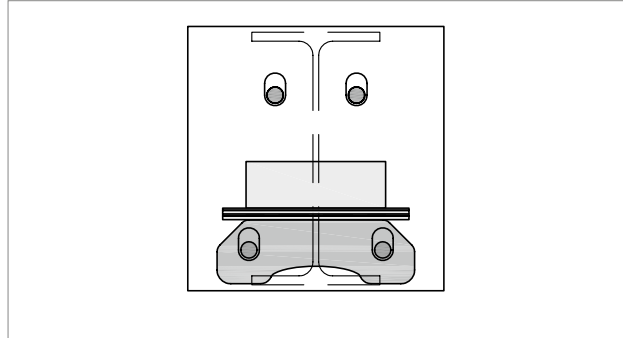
Schöck Isokorb® : raccordement acier - béton armé ; les entretoises de la plaque d'absorption de la charge surélèvent l'emplacement de la poutre en acier de 20 mm maximum.
